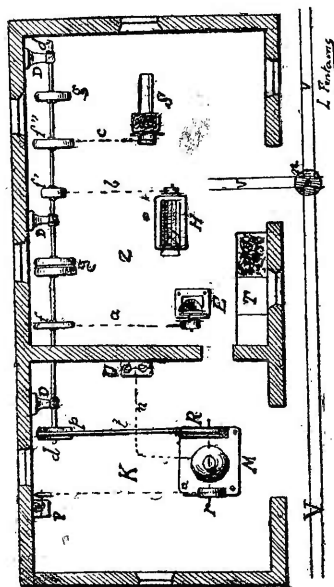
Plan de l'installation d'une salle de préparation des aliments.
